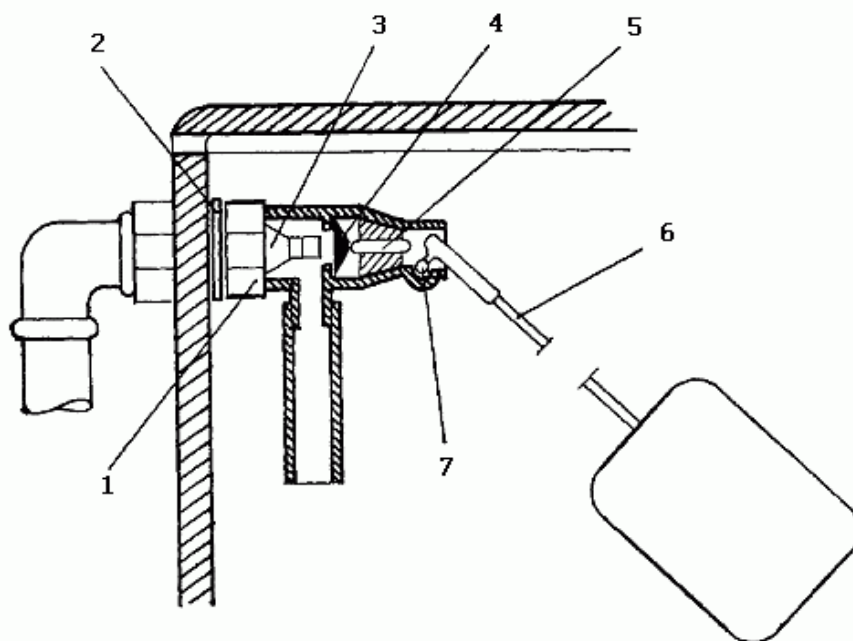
Устройство поплавкового клапана: 1 – прижимная шайба; 2 – прокладка; 3 – седло; 4 – мембрана; 5 – стержень; 6 – рычаг поплавка; 7 – ось рычага
